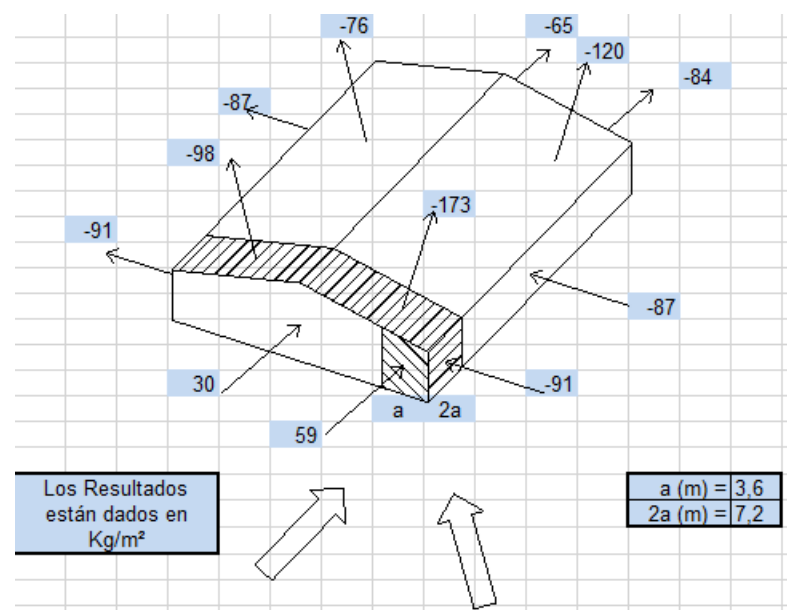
| Esquema de las cargas de viento sobre la estructura
